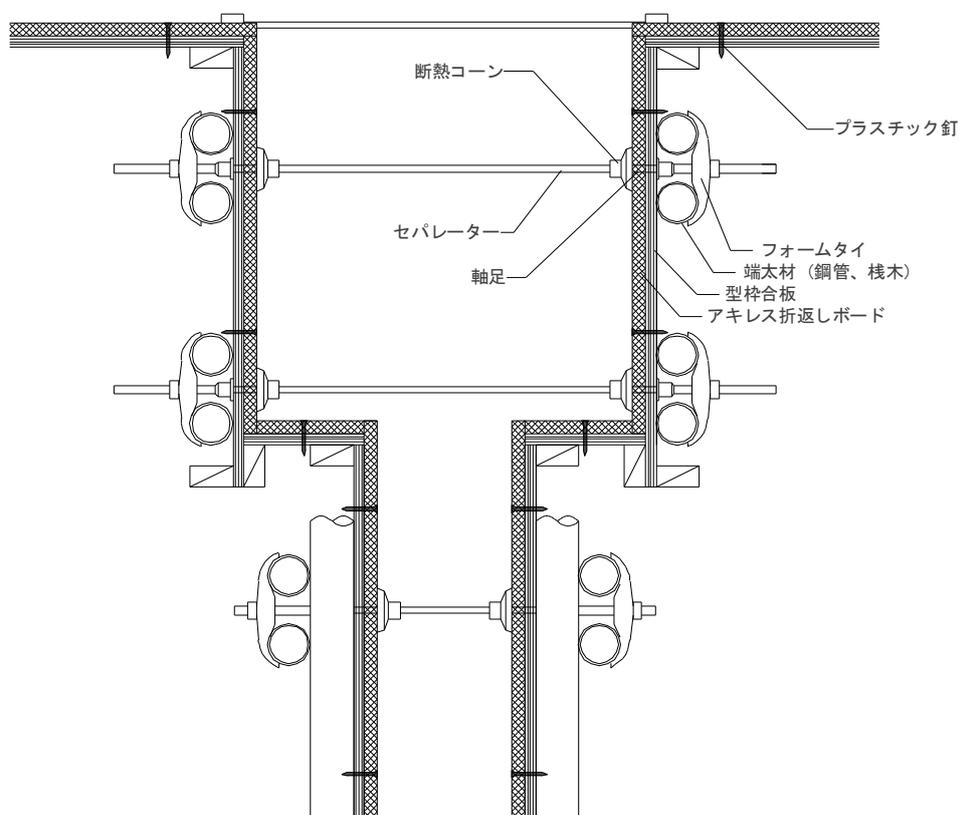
界壁 (梁含む) の施工イメージ図 (断面図)
